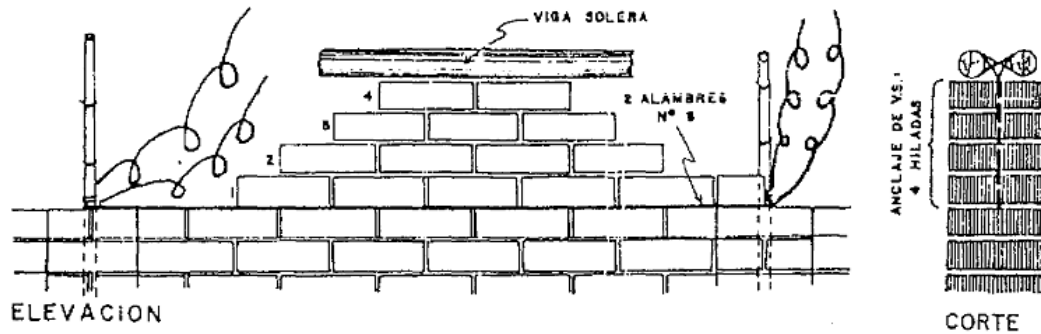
Detalle de refuerzos verticales y de Viga solera.
